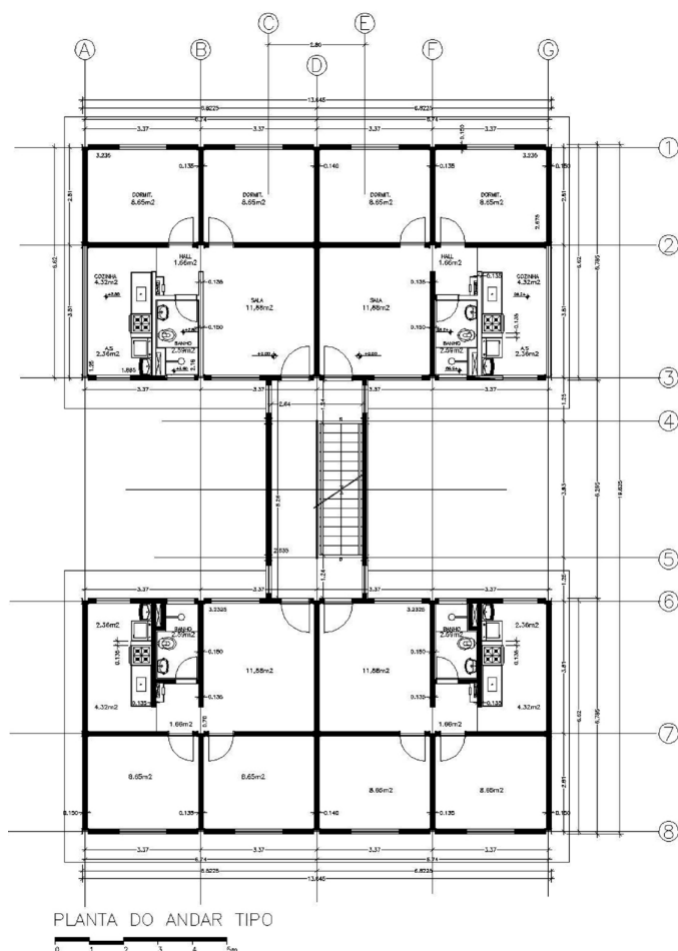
Planta do pavimento tipo do edifício Múltipla - Alphametla. (Fonte: Interamericana de Projetos)
